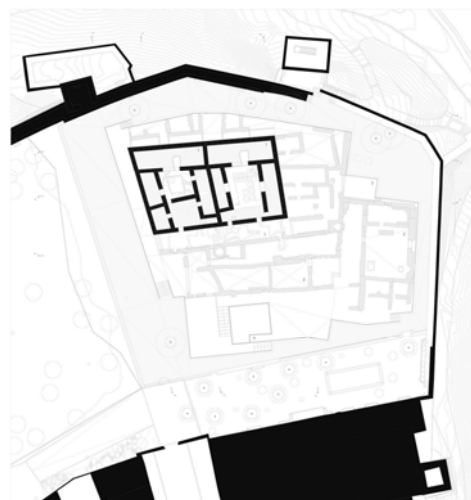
Planta, Musealização da Área Arqueológica da Praça Nova do Castelo de S. Jorge
